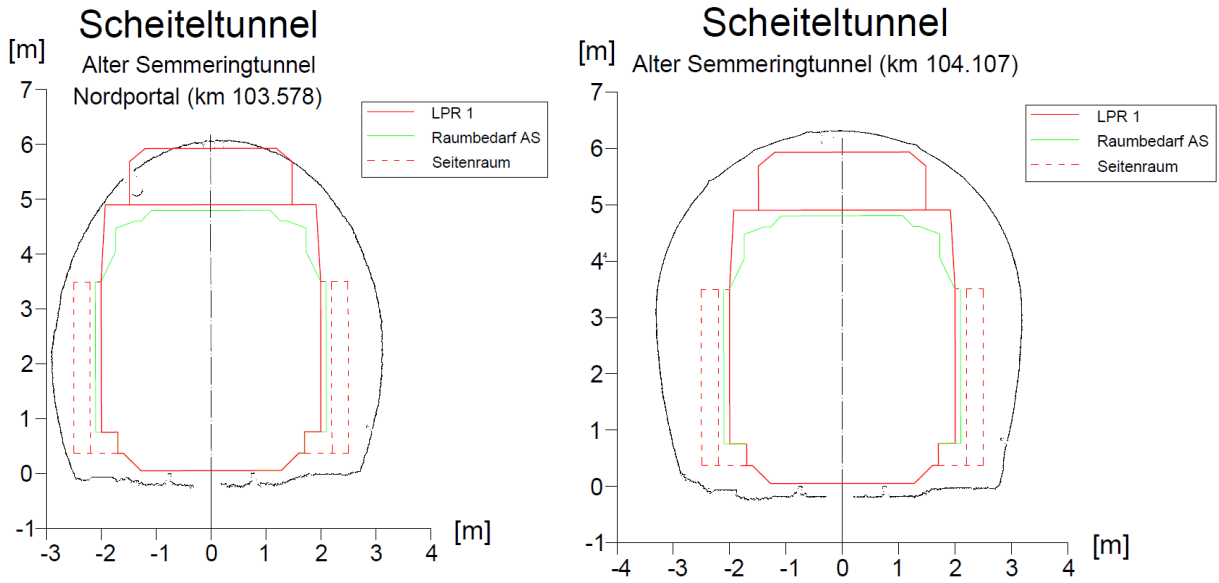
Tunnelprofil Scheiteltunnel (Alter Semmeringtunnel) [87]
